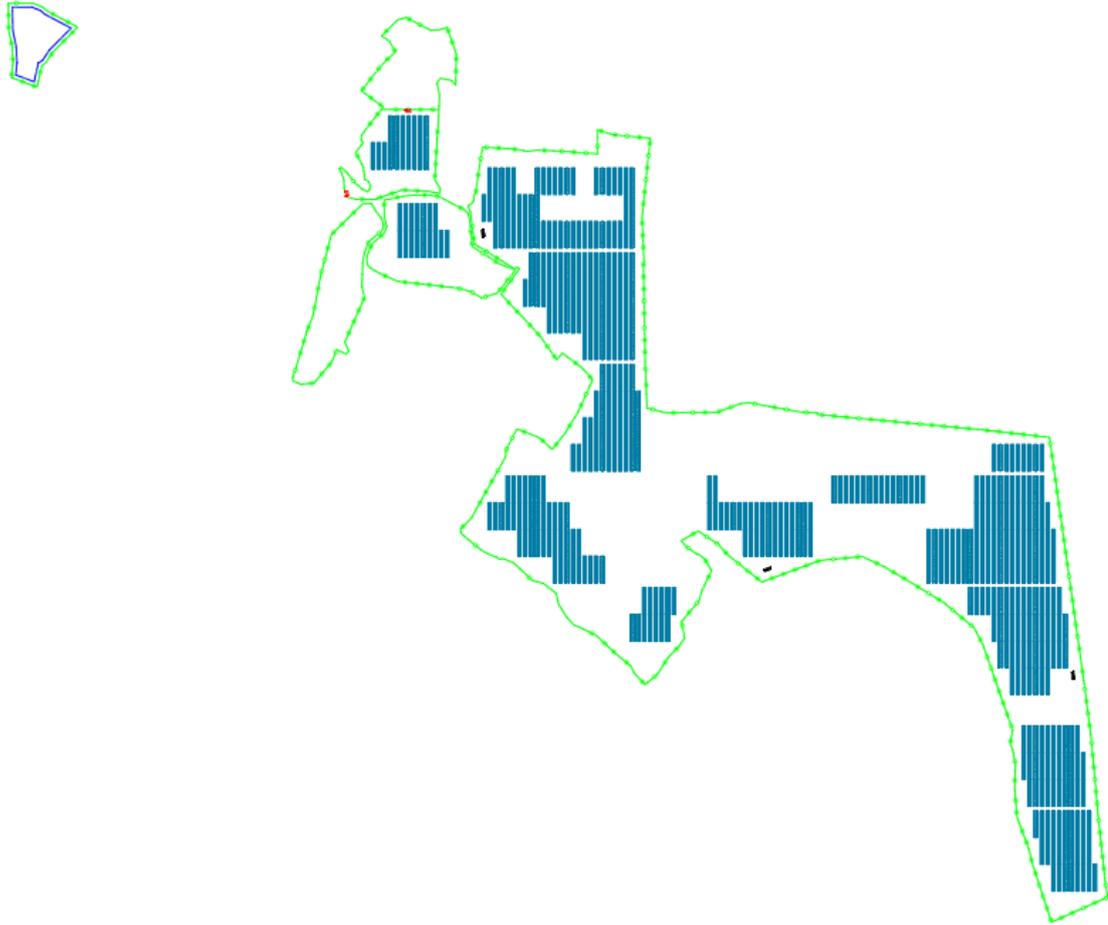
Layout impianto fotovoltaico (LOTTO 1)
